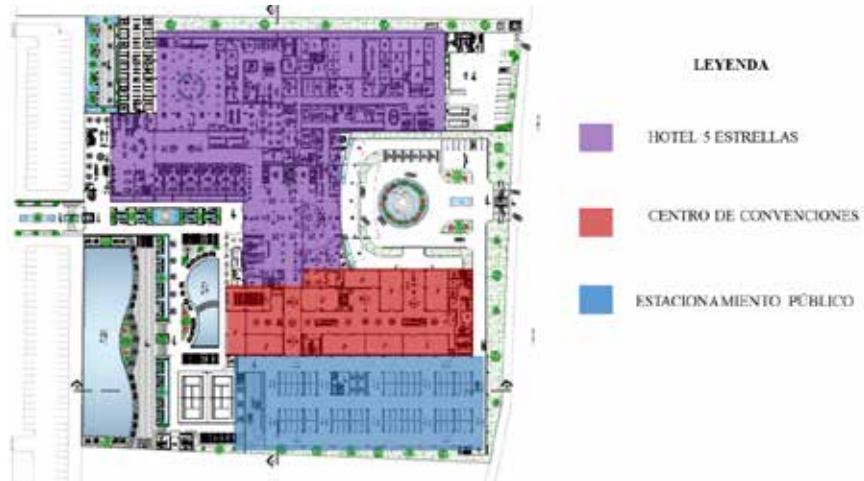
Plano de zonas planta baja (áreas internas). (2017).
